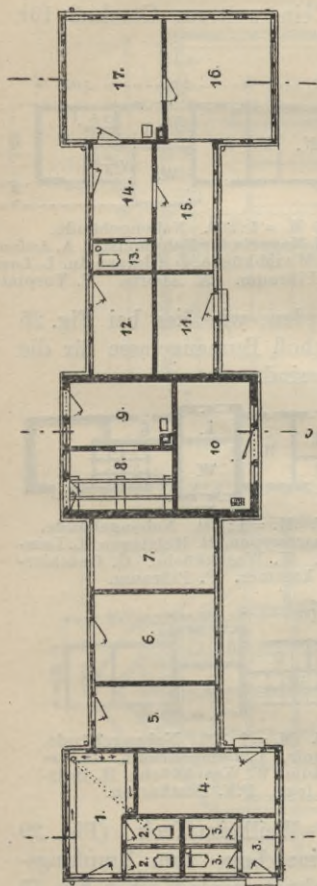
M. = 1 : 267. Nebengebäude Weilheim/Teck. Grundriß.
